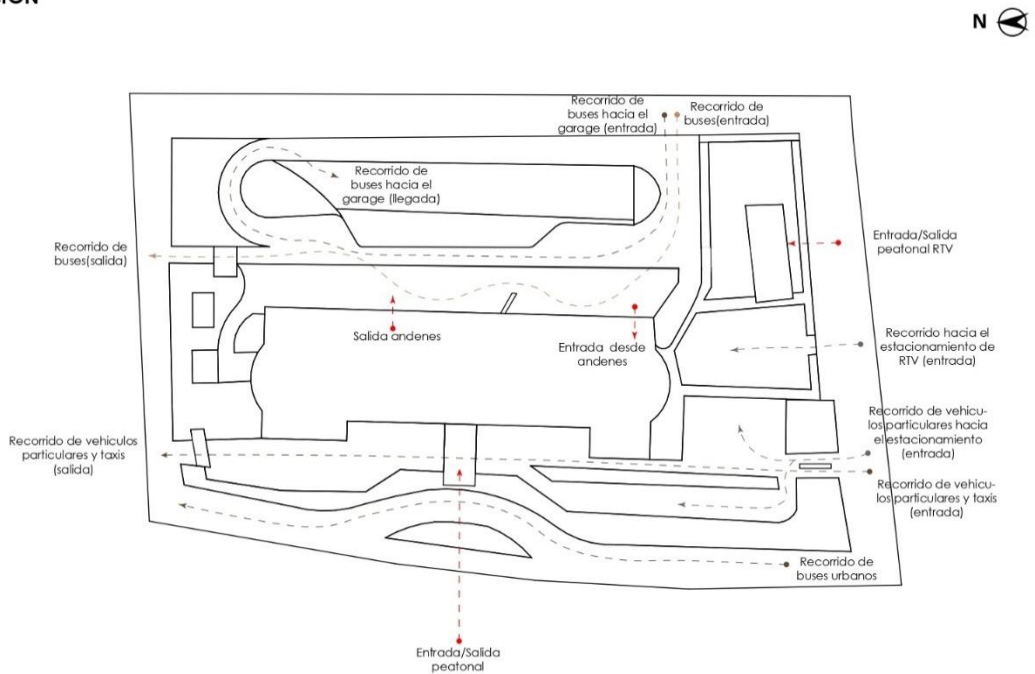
Circulación - Terminal terrestre binacional “Santa Rosa”.
